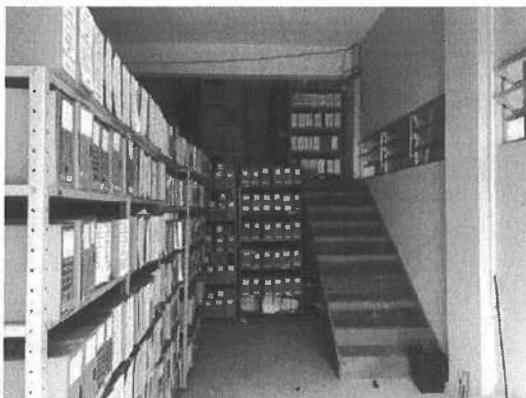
Pavimento térreo - edifício dos fundos (antiga associação).
